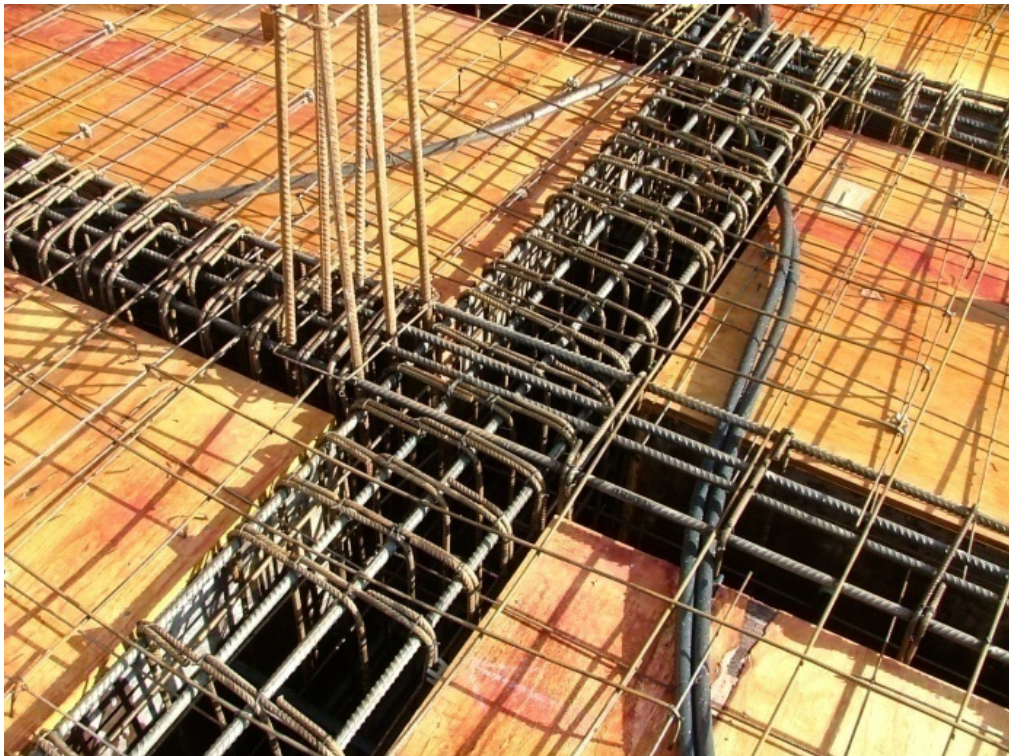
2 - Detalhe da armadura do pavimento tipo
